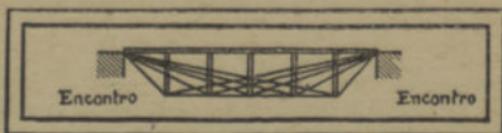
Viga armada composta americana tipo Bollmann (ponte de Louisville sôbre o Ohio).
